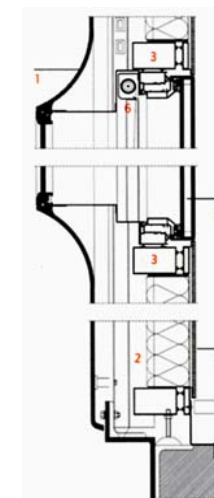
Detail Fassadenschnitt nach Sanierung
